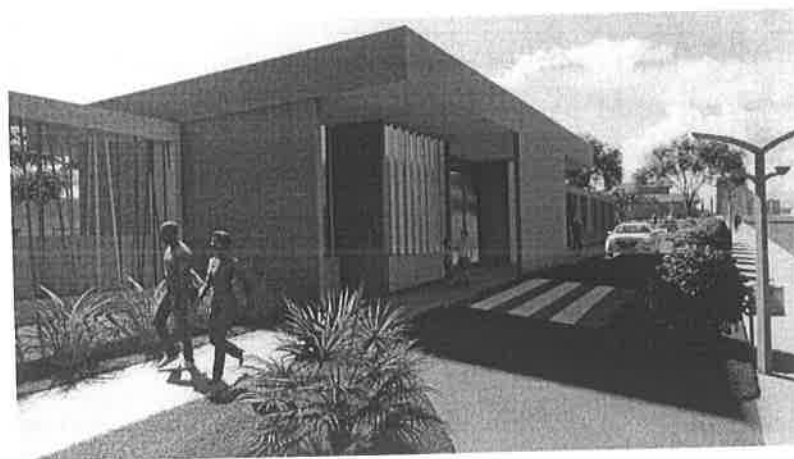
Imagem ilustrativa da fachada frontal com aplicação de revestimento amadeirado.
